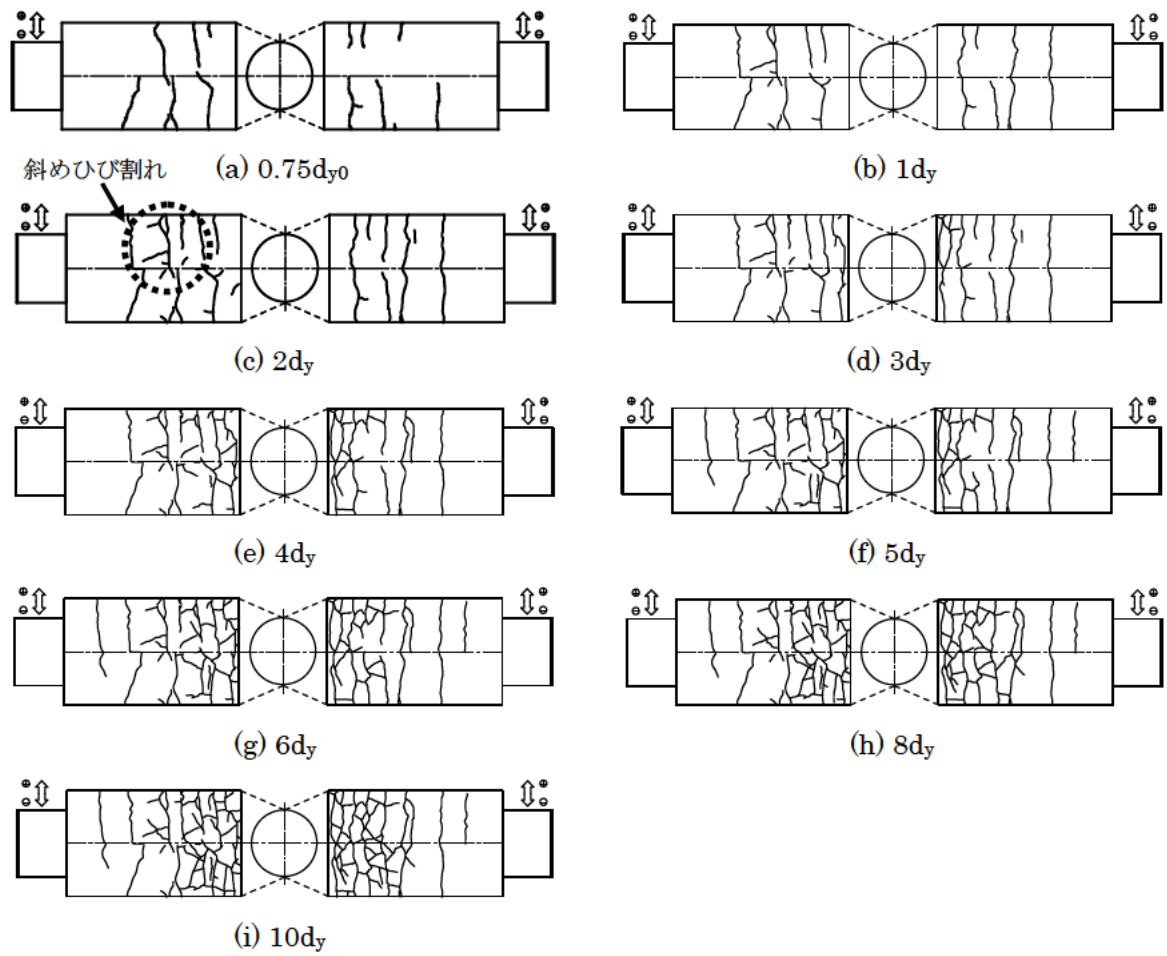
杭体のひび割れ進行状況図 (Case CPP-S-2)
